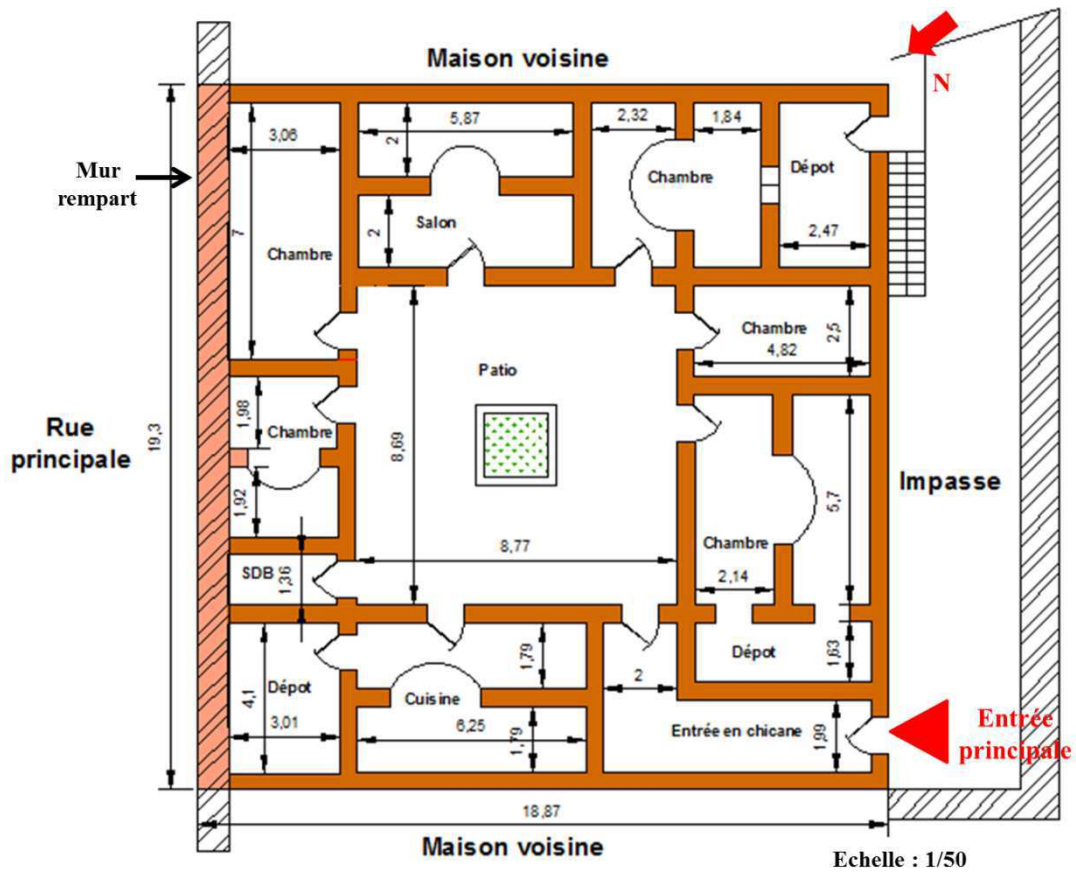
Plan de la maison rempart (l'entrée de l'introvertie)
